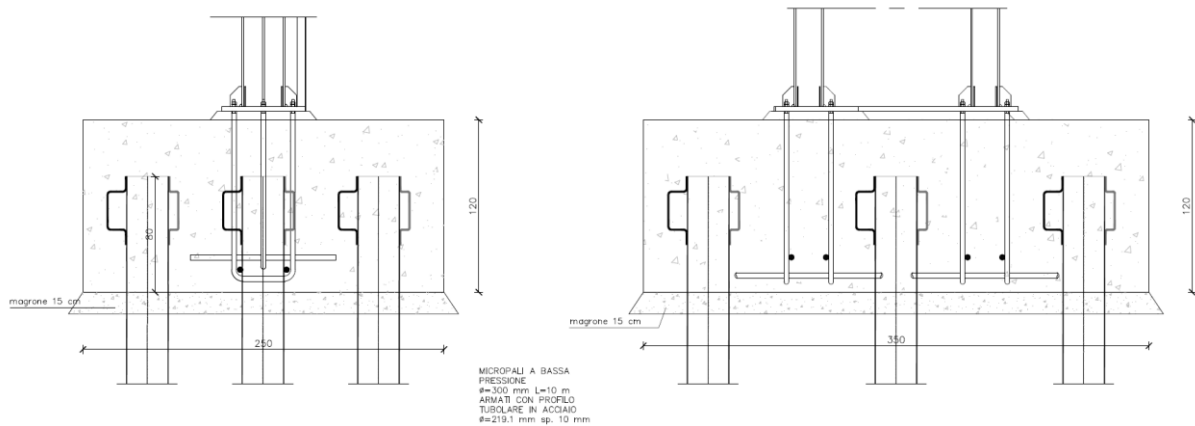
Pannello a messaggio variabile – Plinto di fondazione - armatura
